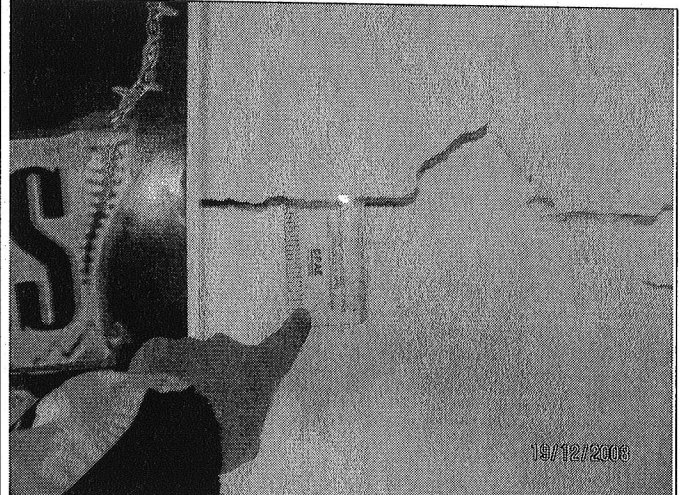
Fisura de 1 cm de ancho aproximadamente, presentada en muro divisorio del lote 1 de la manzana 18 (Observar Figura 1).
